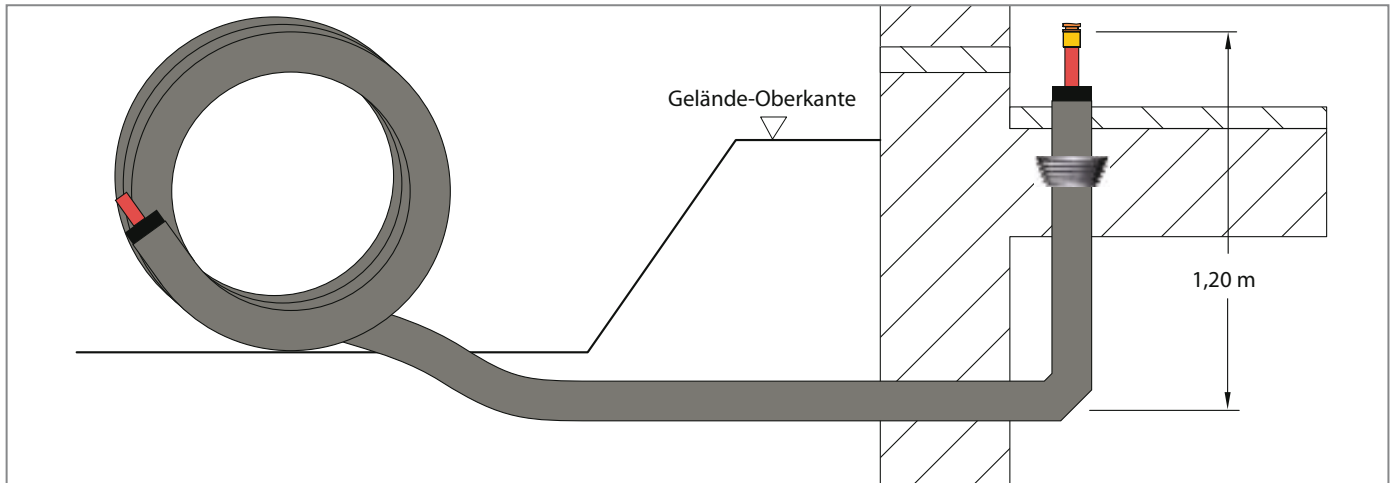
17: Abmessungen Hauseinführungsbogen (flexibel)
